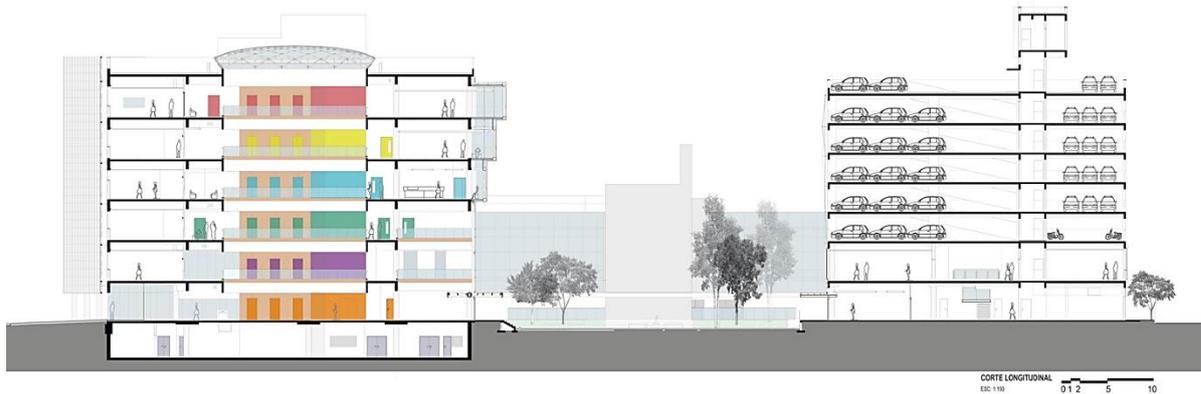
Corte Longitudinal Senac São Miguel Paulista
